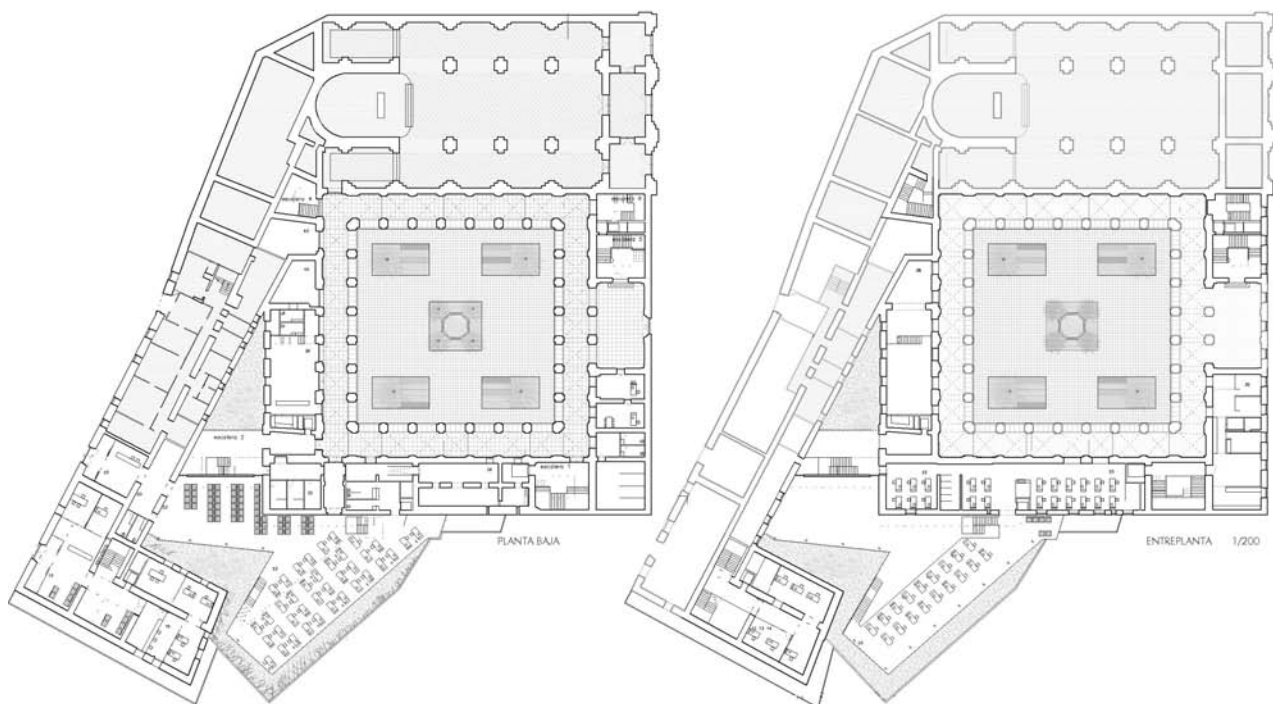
Plantas generales de la propuesta. Niveles inferiores
